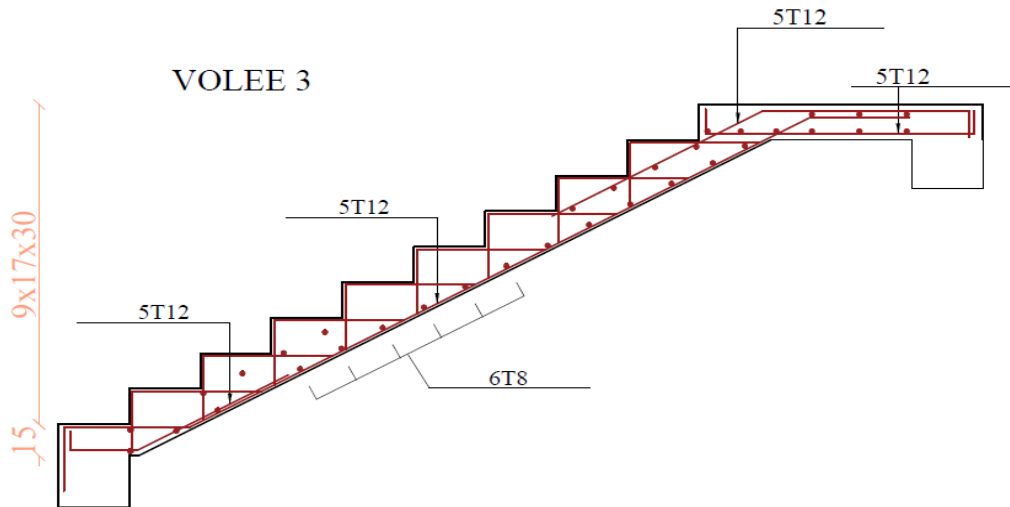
Schéma de ferrailage du 3^{ème} Type d'escalier.
